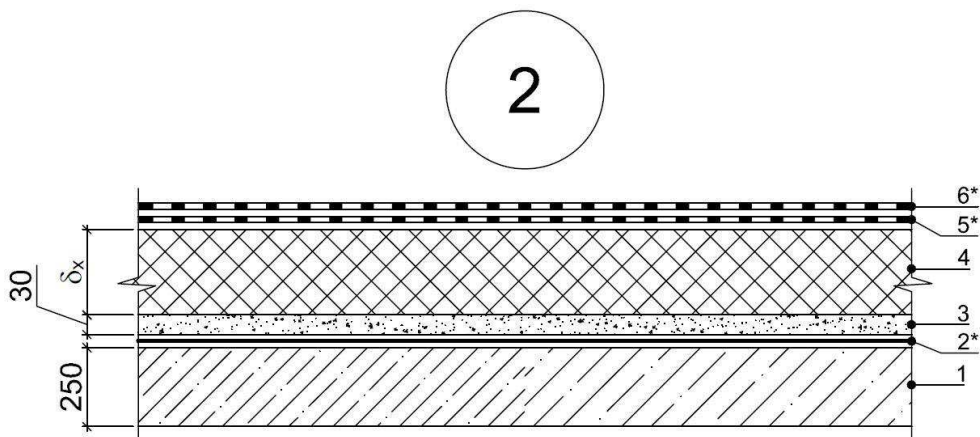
Вариант 2 конструкции покрытия (традиционного)
